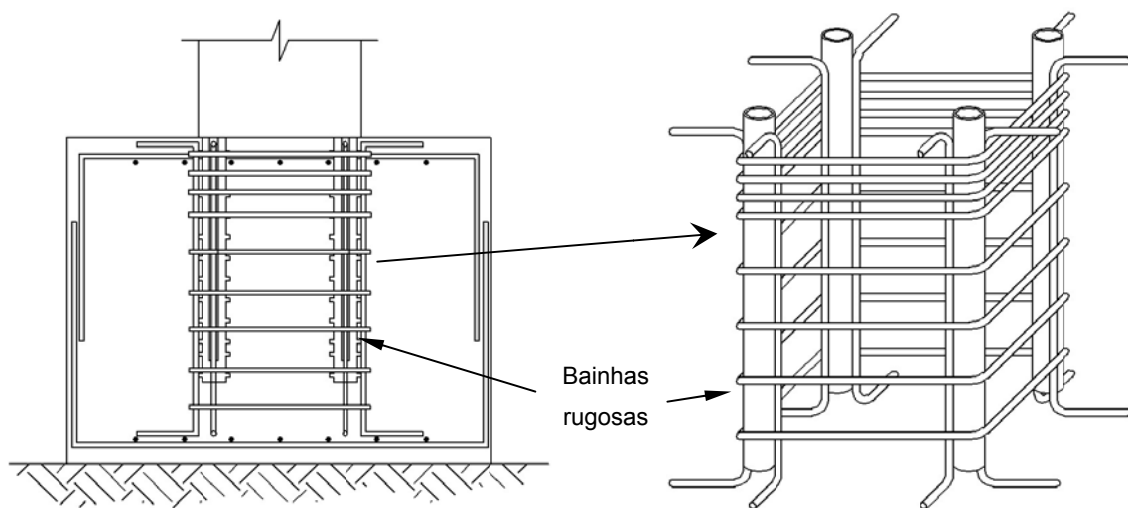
Ligação pilar – fundação através de bainhas existentes na sapata
